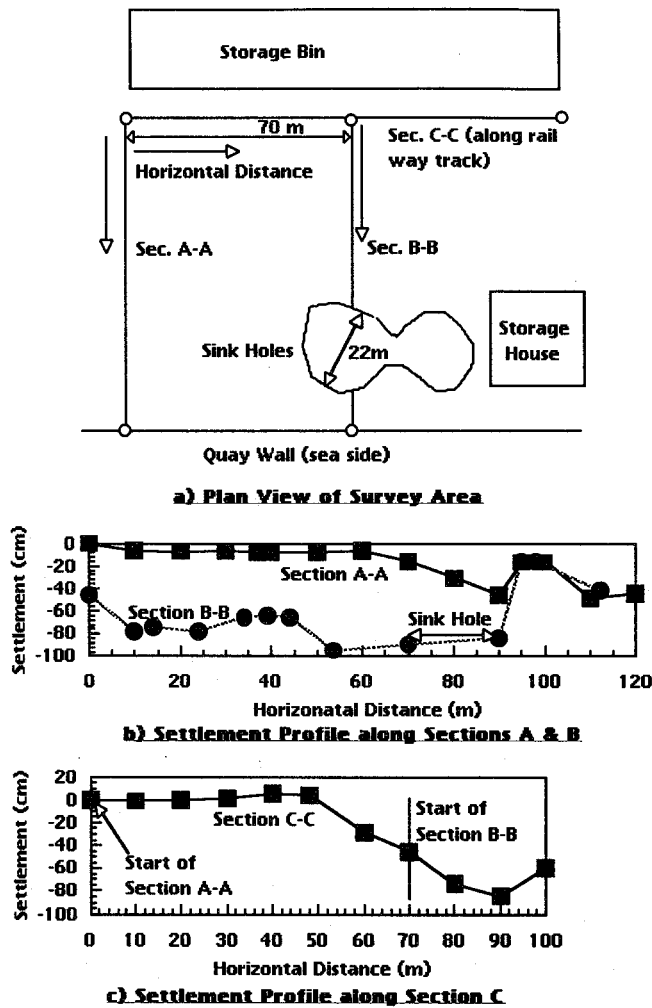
台中港測量位置図 a) 平面図, b) A 断面計測結果
